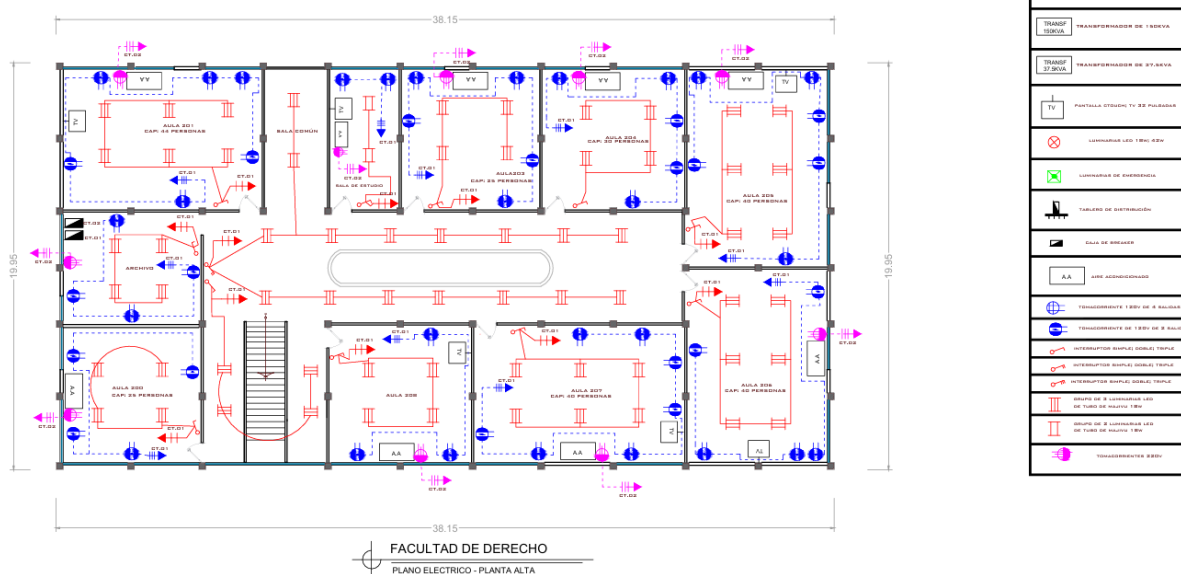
Plano eléctrico de la segunda planta de derecho; Fuente (elaboración propia)
